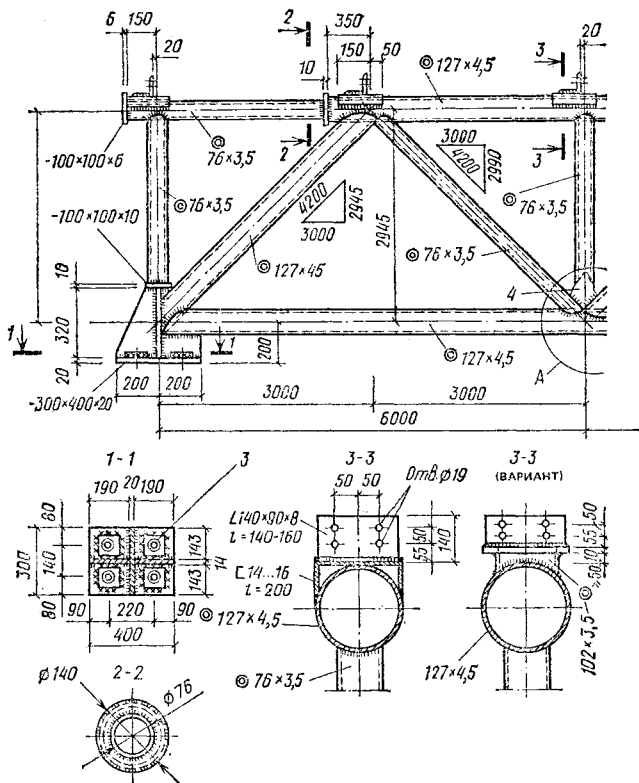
Стропильная ферма из труб и детали узлов для устройства кровли по прогонам
